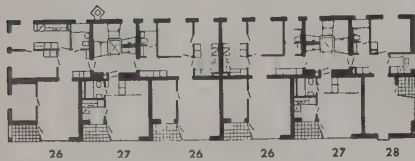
Grundriß des 12 geschossigen Wohnhauses in Västertorp
